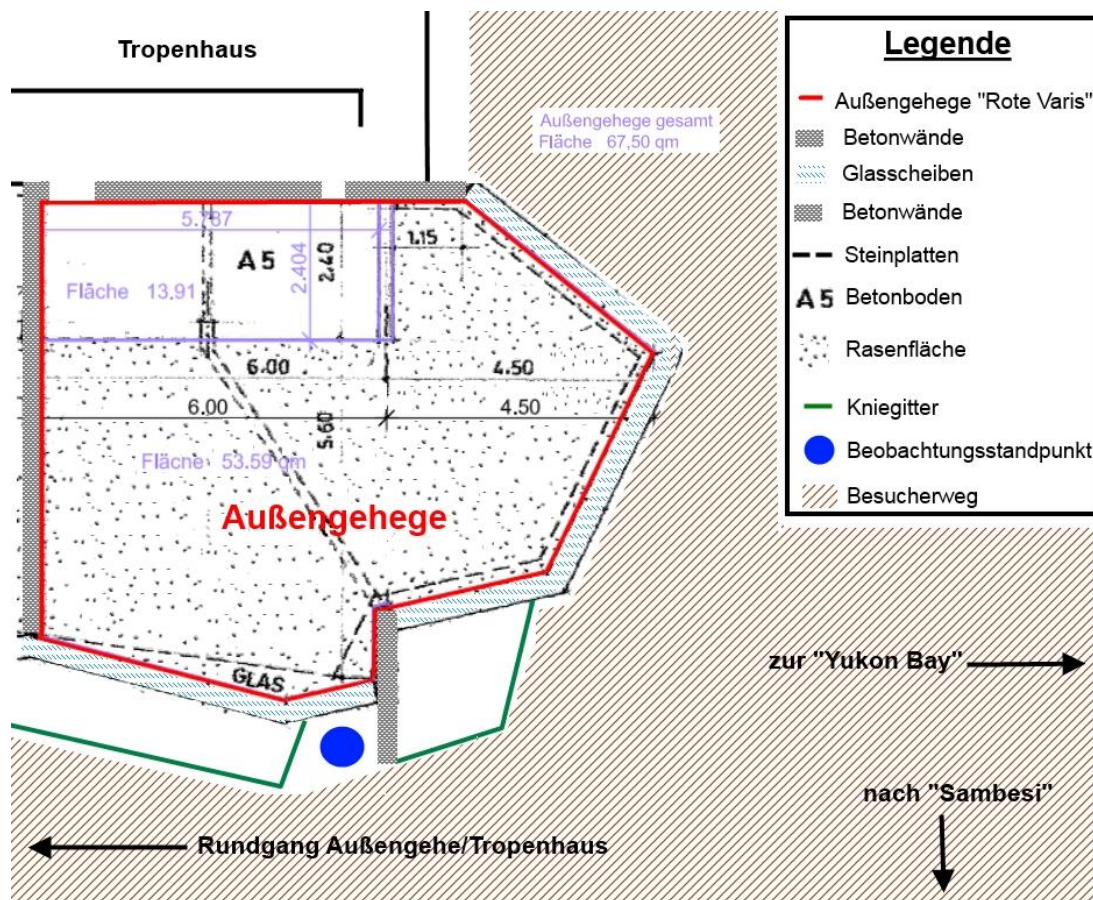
Grundriss Außengehege Rote Varis (verändert nach Anhang 2)
